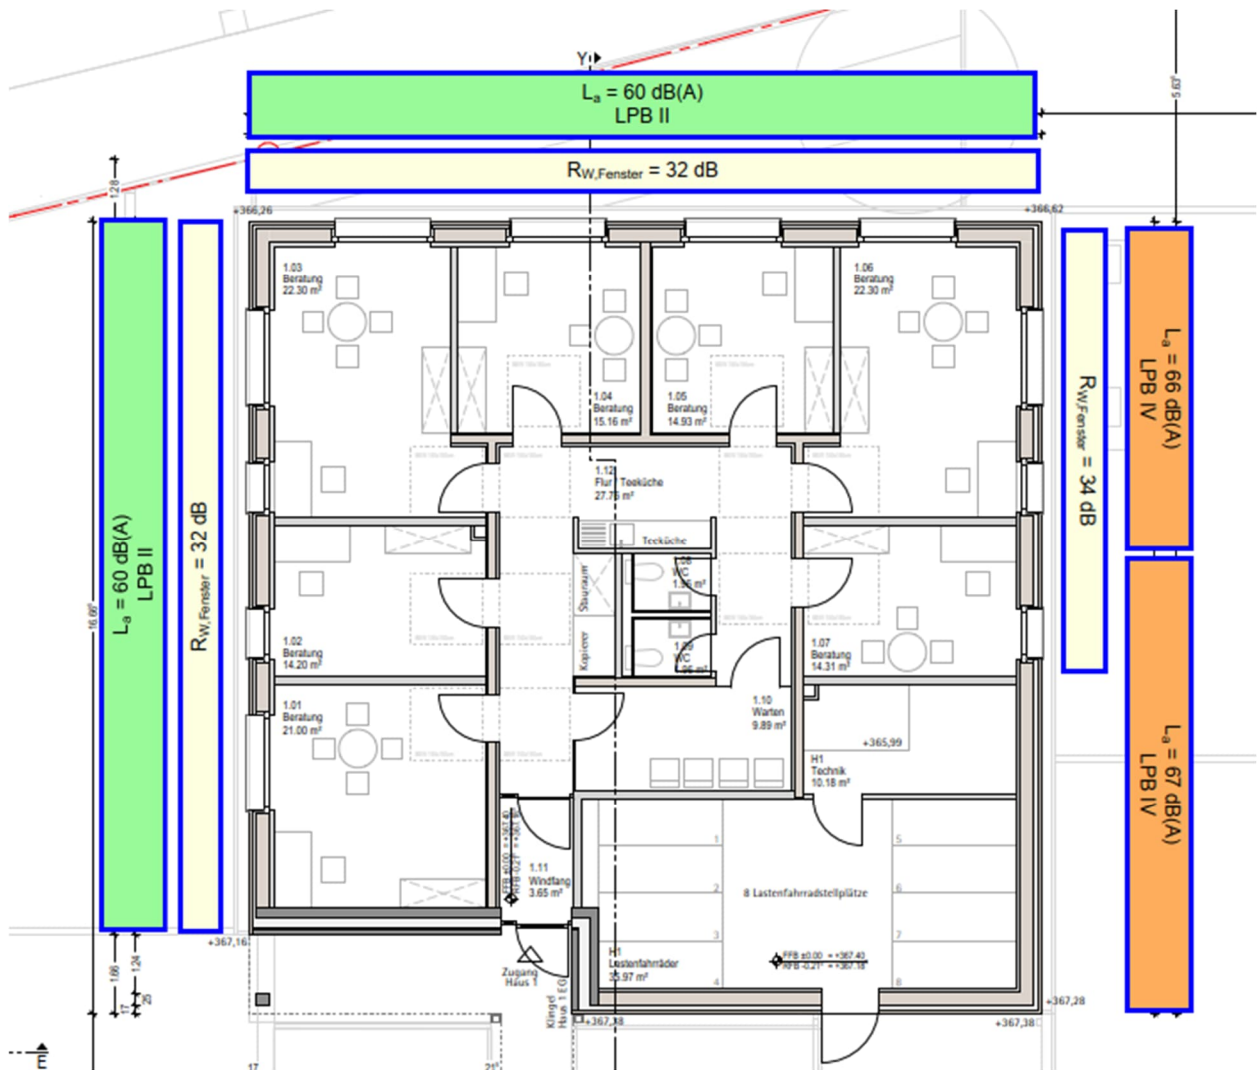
Außenlärm – Grundriss EG – Haus 1
